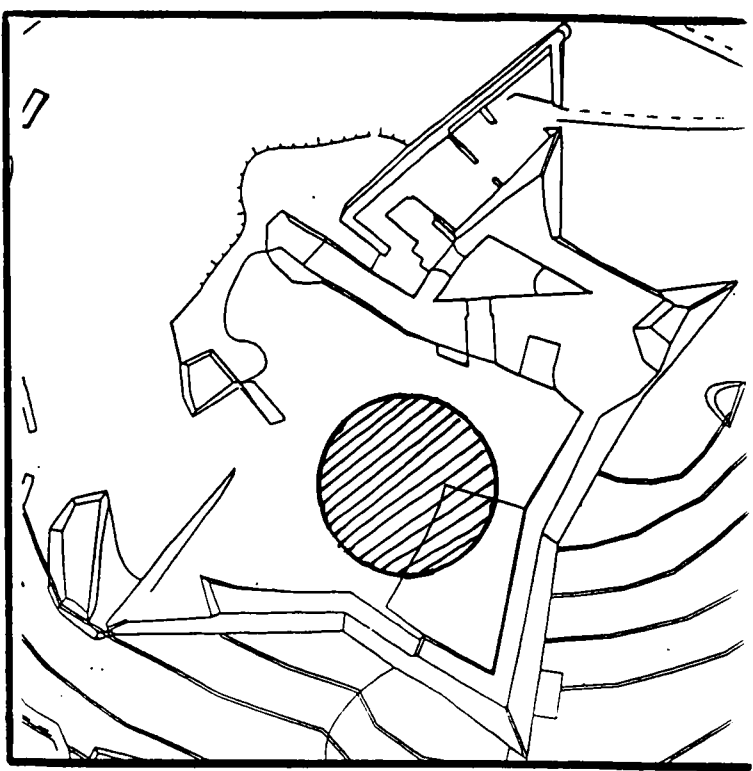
Croquis - Planta subterrània, part central (pta NE + pta SE)
